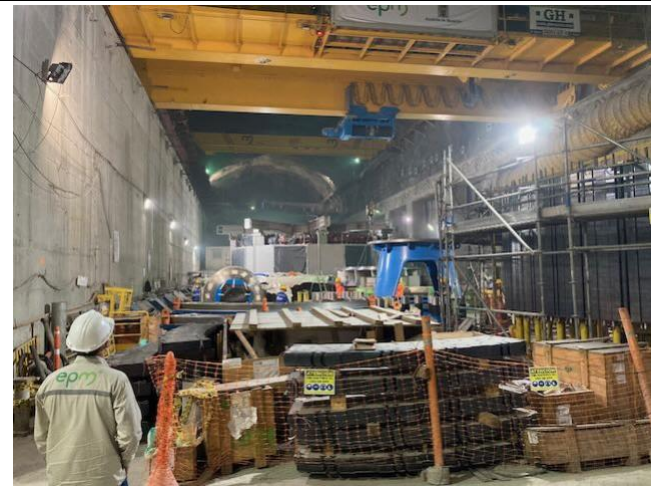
Restricciones de espacio en la caverna de la central eléctrica
